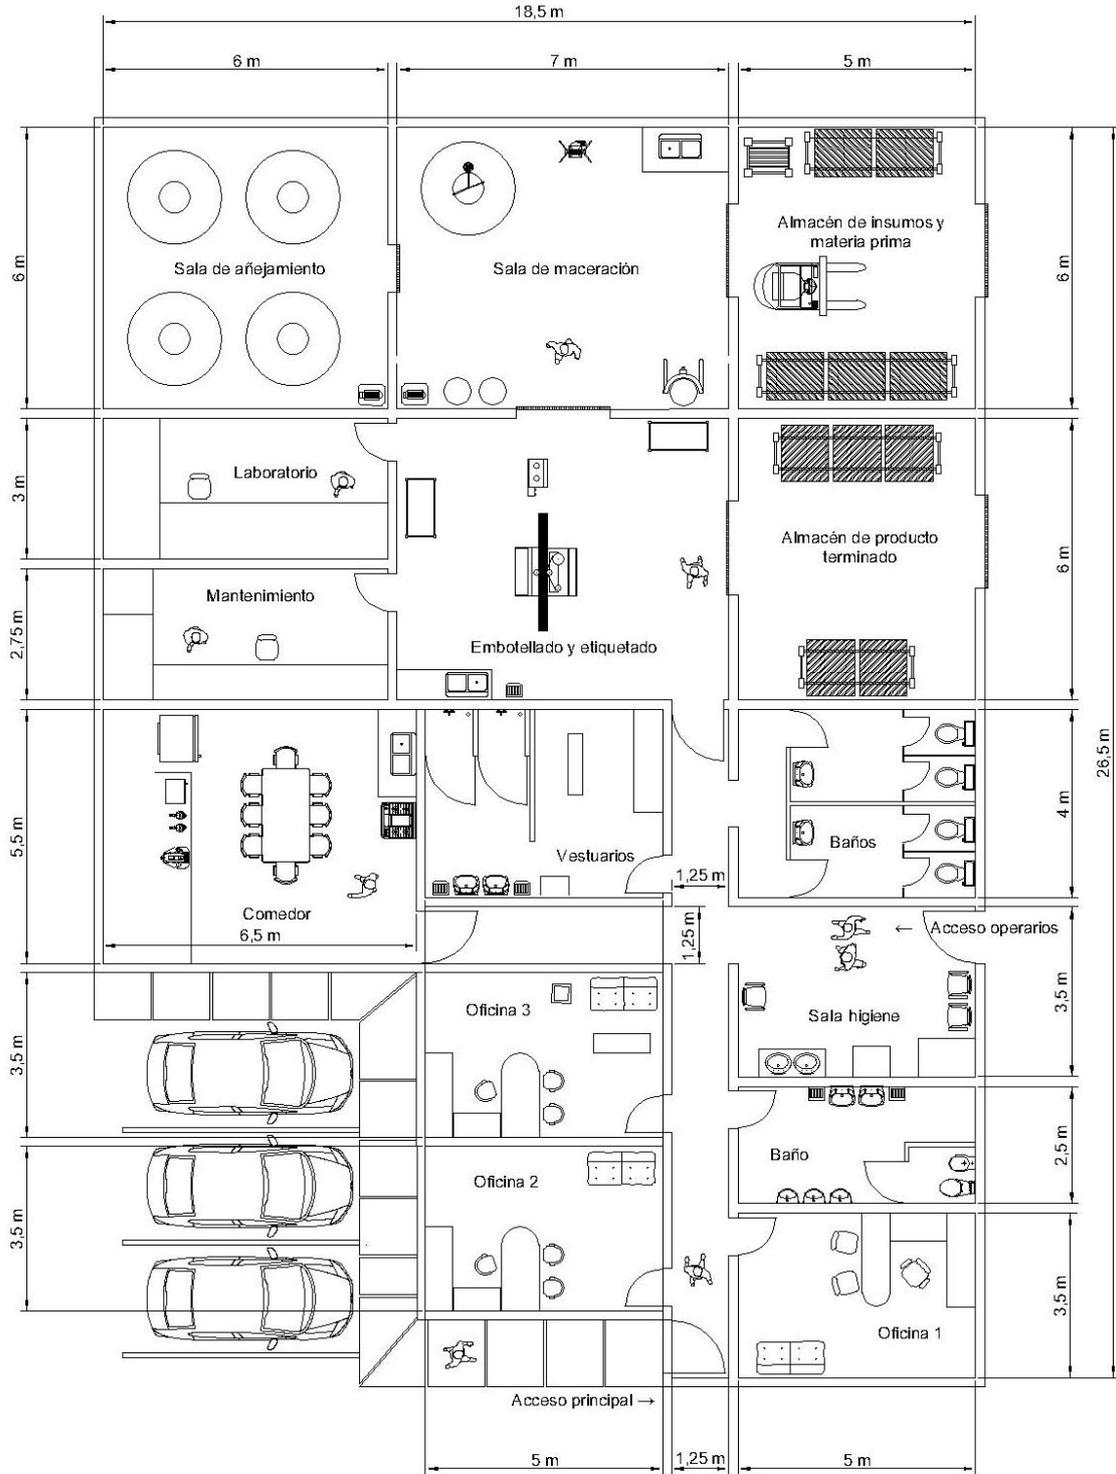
LayOut planta completa; Fuente: Elaboración propia.
